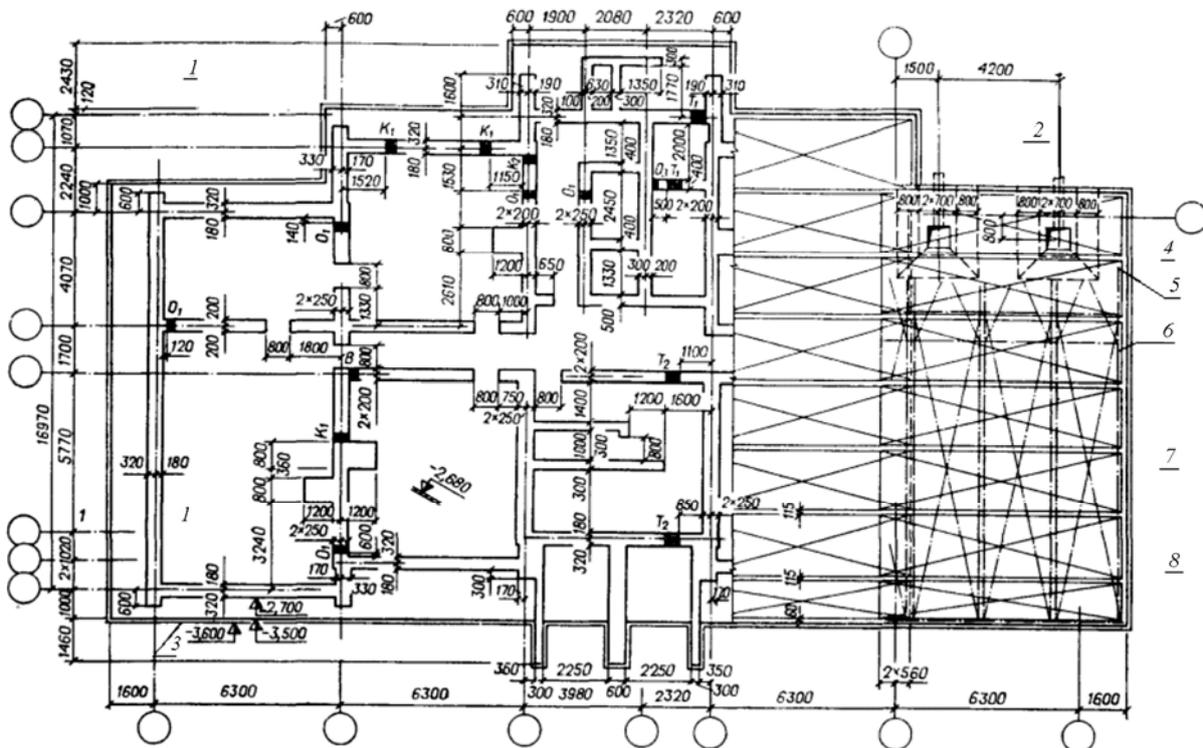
Плитный фундамент под здание повышенной этажности. План фундамента 14-этажного здания с кирпичными стенами: *1* — стены подвала из бетонных блоков толщиной 500, 400 и 300 мм; *2* — ввод водопровода, гильза из $\varnothing 426$, ось на $-3,600$; *3* — подготовка из бетона марки 100; *4* — колодцы 800×800 ; дно на $-4,050$; *5* — верхние сетки нижнего ряда; *6* — нижние сетки нижнего ряда (условно показаны частично); *7* — перекрестные верхние и нижние сетки, которые образуют решетку рабочей арматуры с ячей 150×150 ; *8* — нижние сетки нижнего ряда, которые укладывают на бетонные подкладки высотой 35, каркасы устанавливаются непосредственно на бетонную подготовку, нижние сетки верхнего ряда укладываются на каркасы
